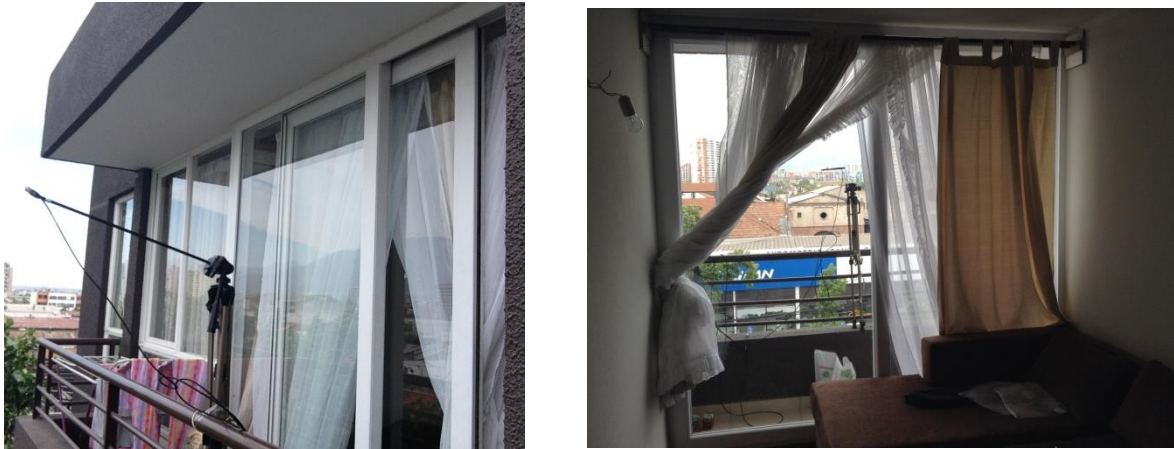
Vista exterior e interior de la fachada utilizada para el ensayo.
